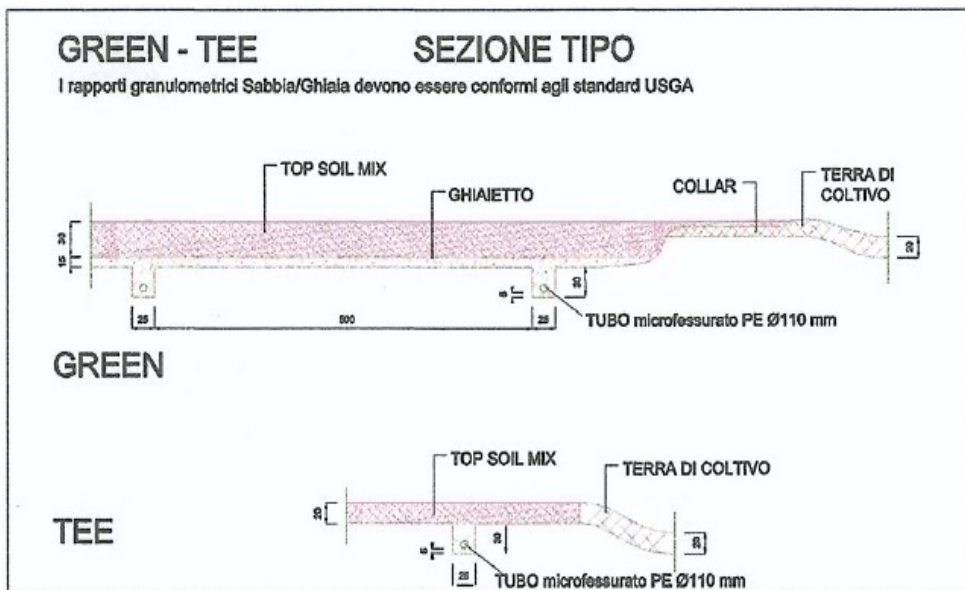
sezione tipo dell'impianto di drenaggio dei greens e dei tees
